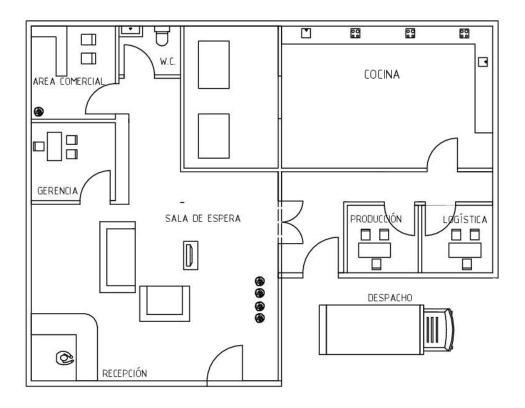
Planta arquitectónica de oficina y planta de producción de Chester´s CIA.LTDA. Elaborado por: Autores.
